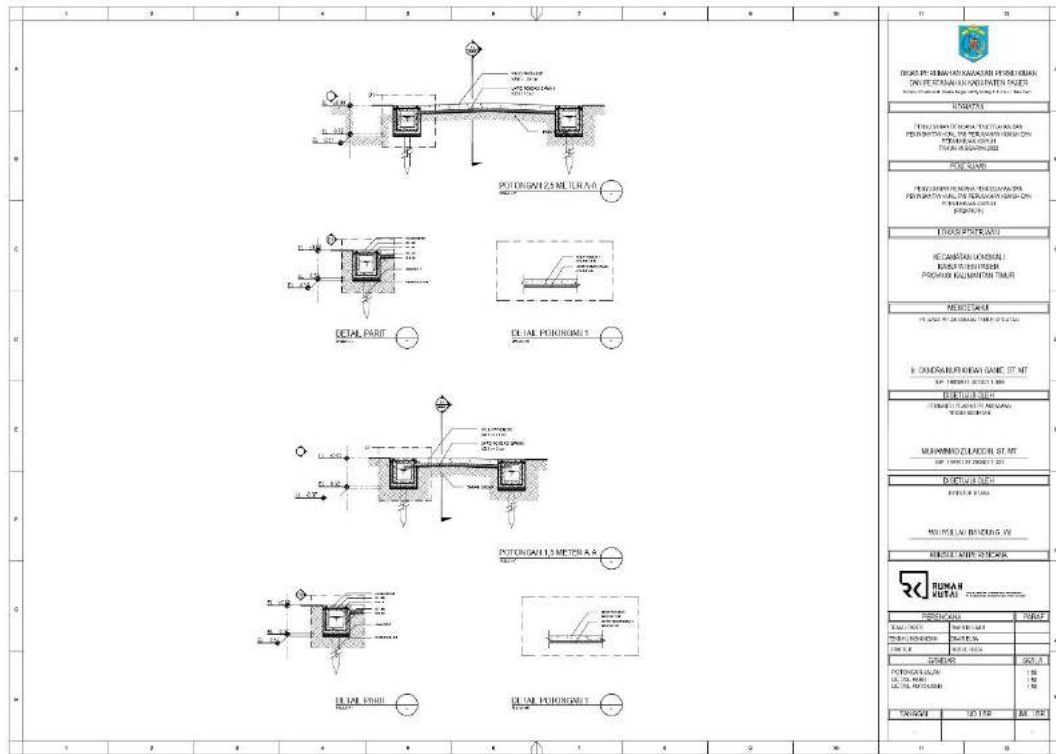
59 Konsep Rencana Jalan Segmen 8 RT.11
